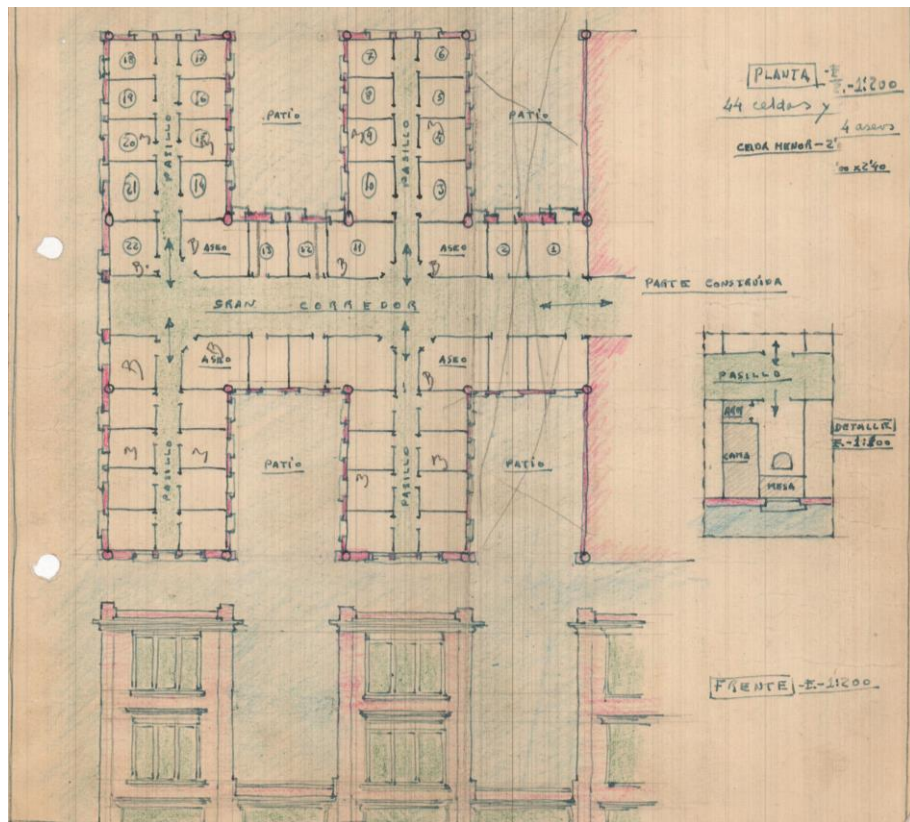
Alzado y planta del edificio residencia del colegio La Salle
